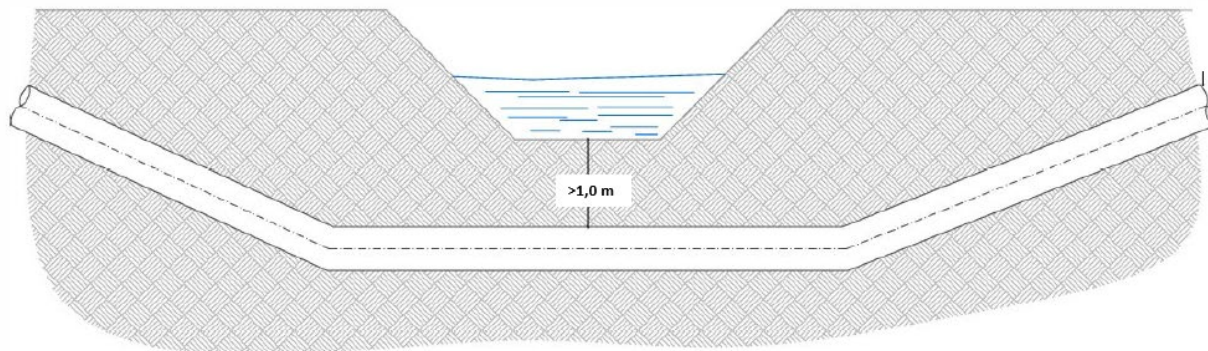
Particolari costruttivi: schema tipo attraversamento sub alveo
